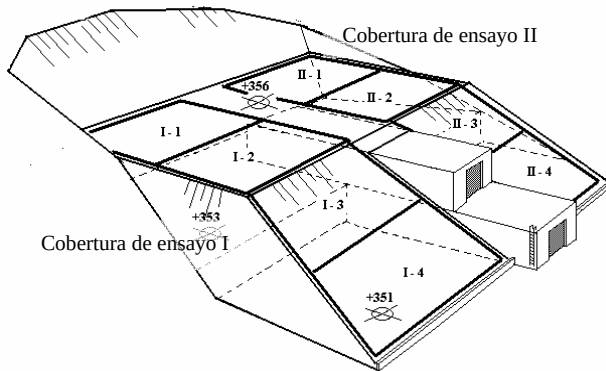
Vista general del sistema de las dos coberturas y su división en secciones para las zonas de instrumentación.
